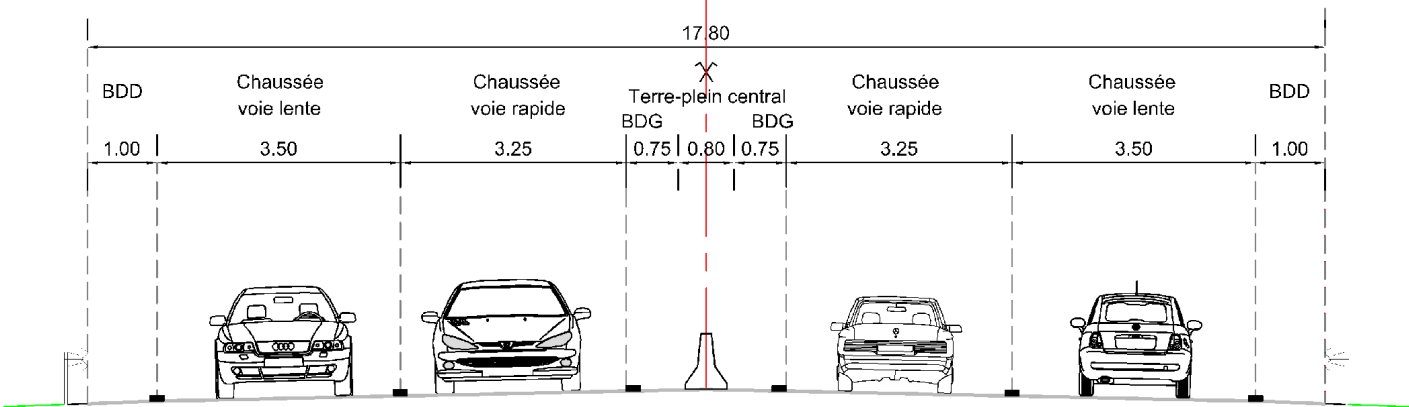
Profil en travers pour route à 2x1 voie à chaussées séparées au niveau des créneaux de dépassement
